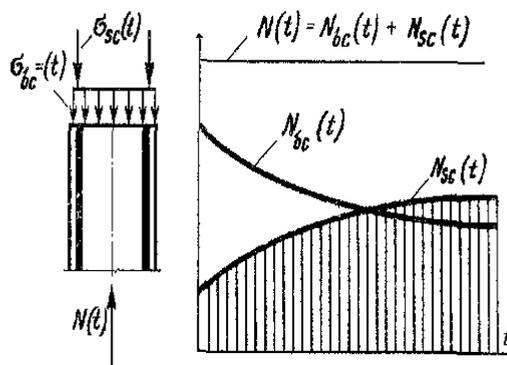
Перераспределение усилий между арматурой и бетоном
